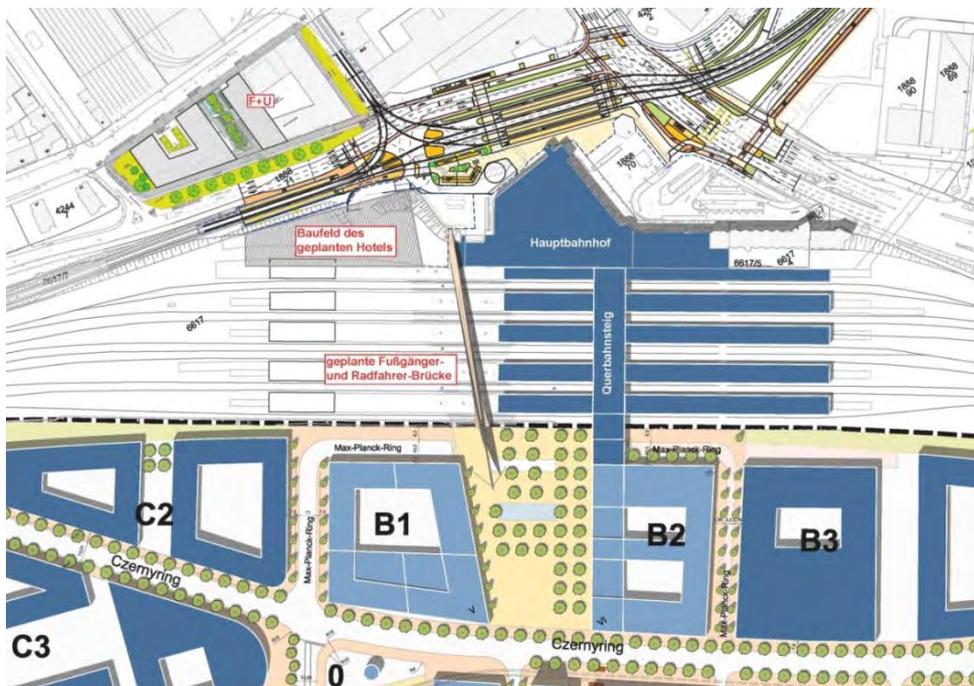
Ausschnitt aus Rahmenplan Bahnstadt mit Fußgänger- und Radfahrer-Brücke und Baufeld des geplanten Hotels der DB, Quelle: Stadtplanungsamt
